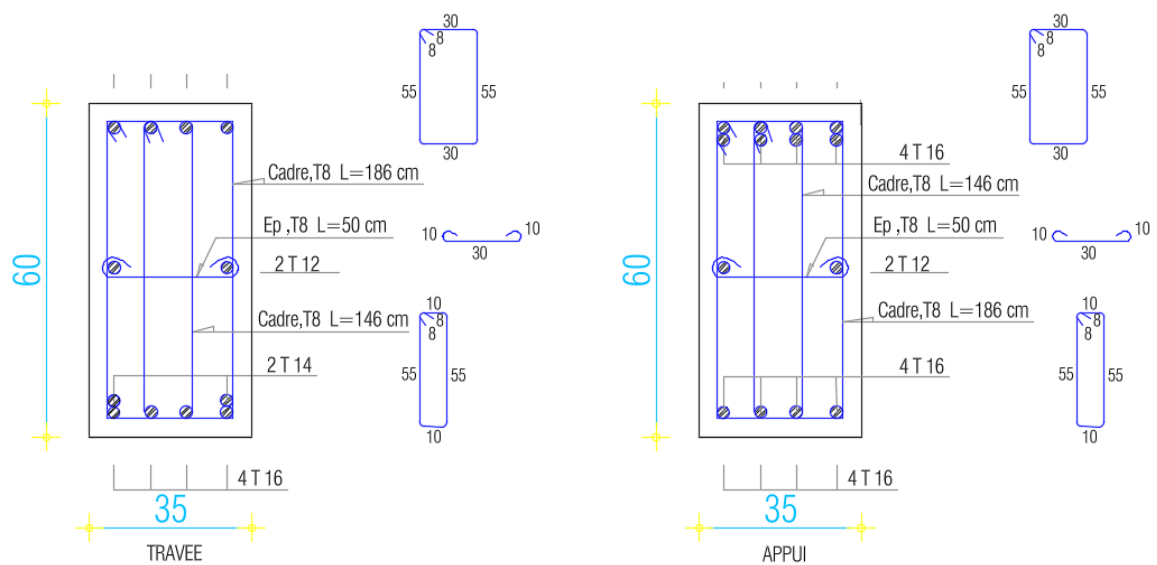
Schéma de ferraillage de la poutre principal 35x60 avec voile sur travée et appuis
